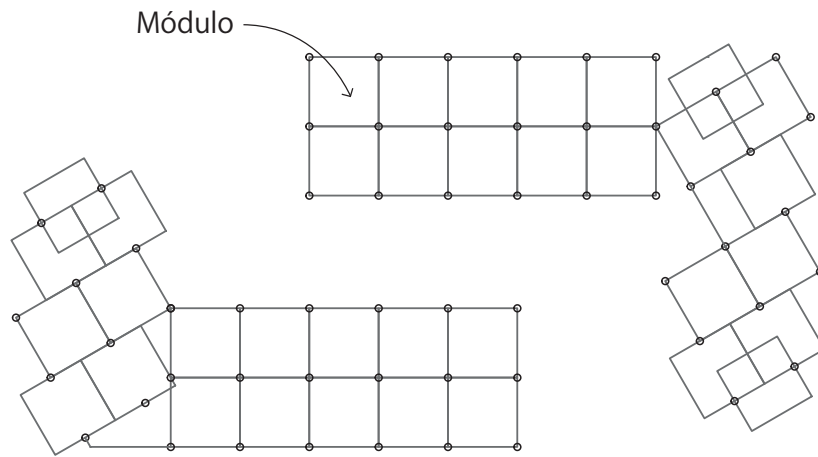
Estructura por módulos. Elaborado por ZVMM.
